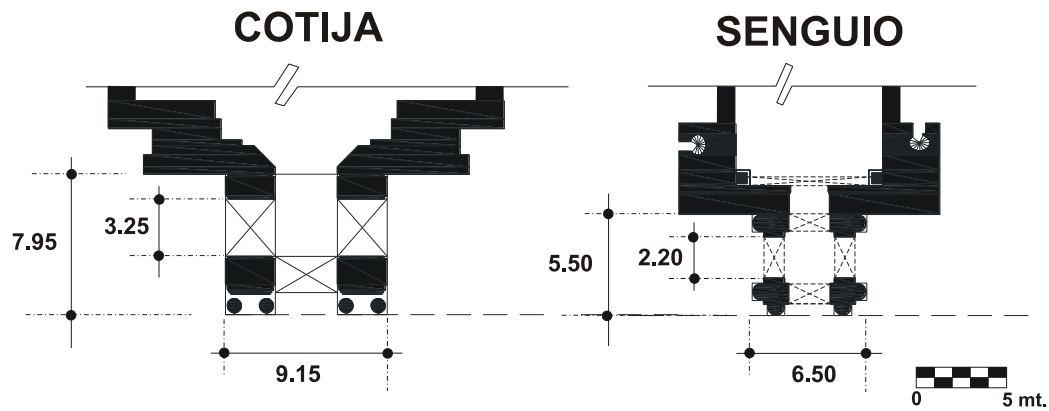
VARIANTE DE PLANTA TIPO 1
